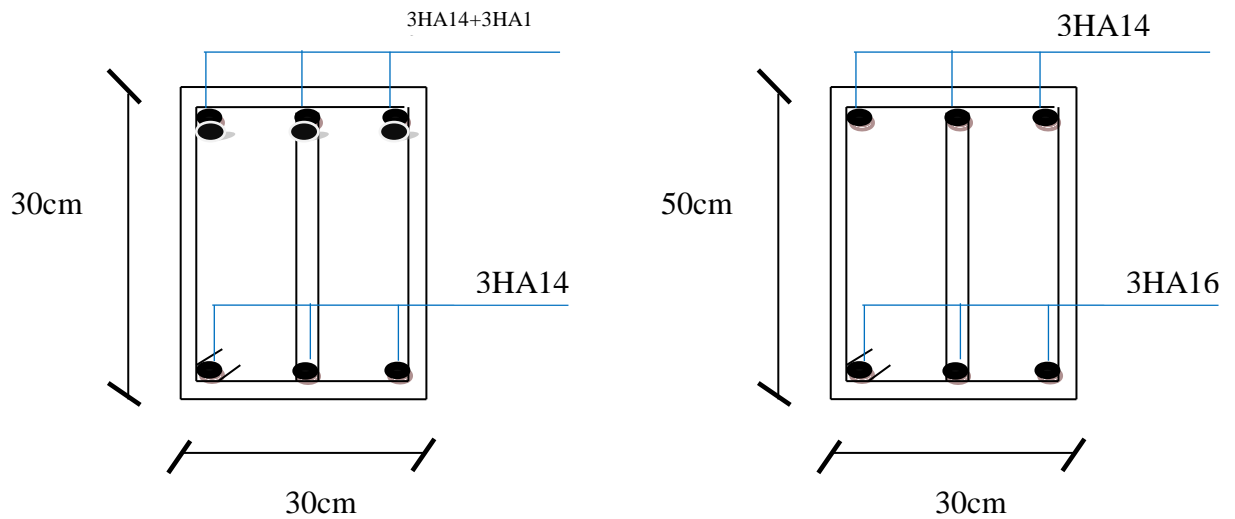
Schéma de ferrailage longitudinale de la poutre p
